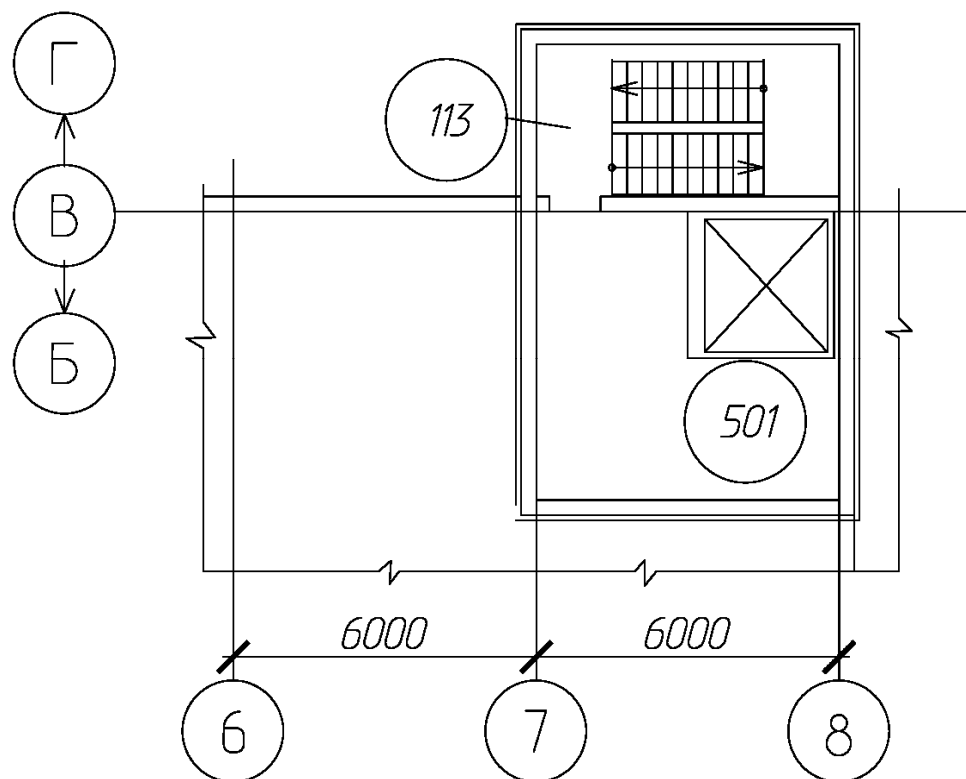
Здание приемки. План на отметке 16,200
